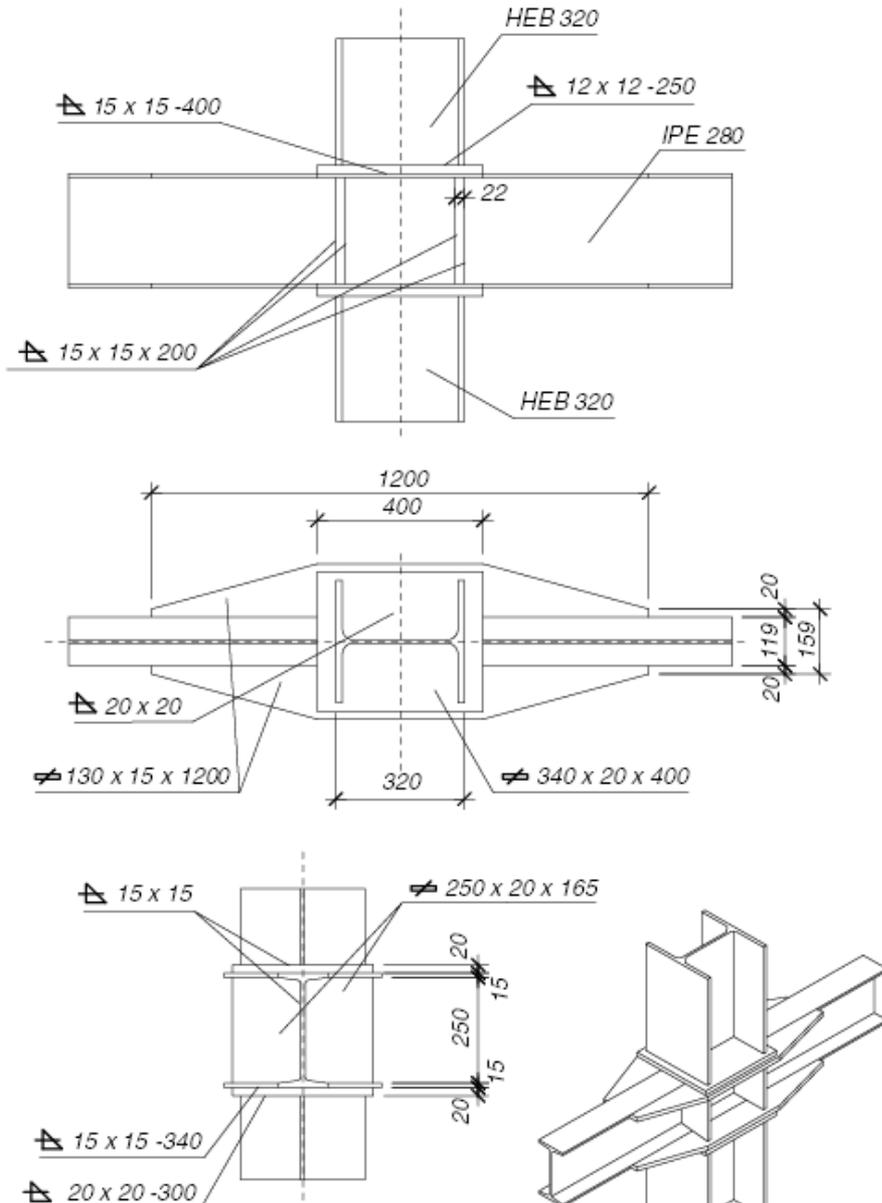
/5 ATTACCO TRAVE (Passante) – COLONNA
